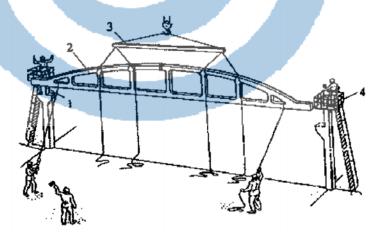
Процесс монтажа фермы. Монтаж и закрепление ферм на опорах колонн 1 - оттяжка; 2 - ферма; 3 - траверсы; 4 - лестница.
